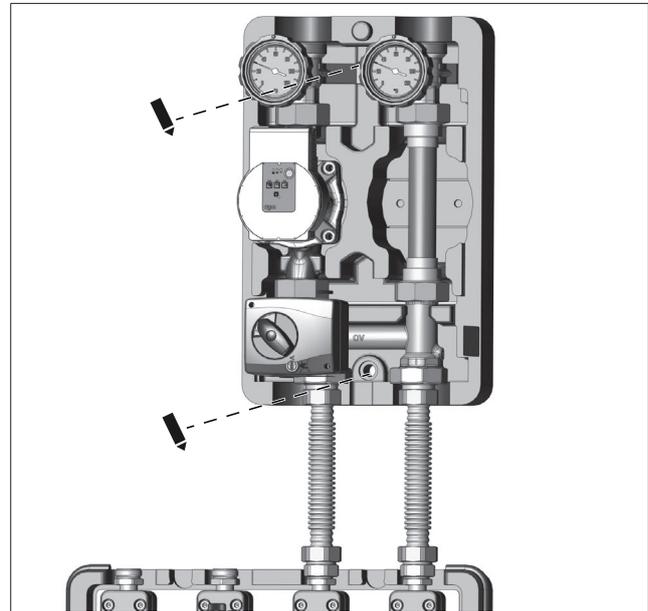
Vissage du groupe avec circulateur (raccordement par le haut)
